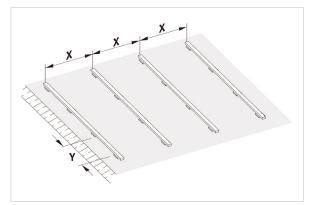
Укладка с резиновыми прокладками на бетонном полу
